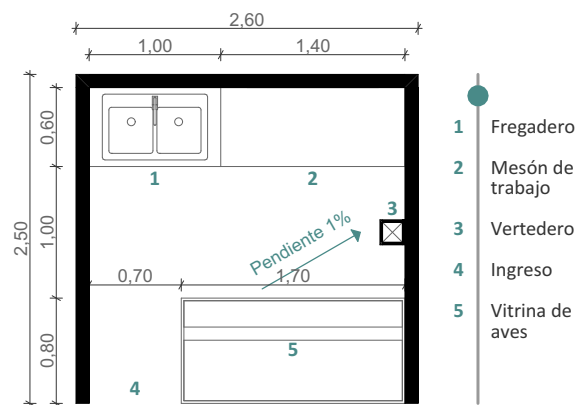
Planta de pollería. Fuente: Autores.
